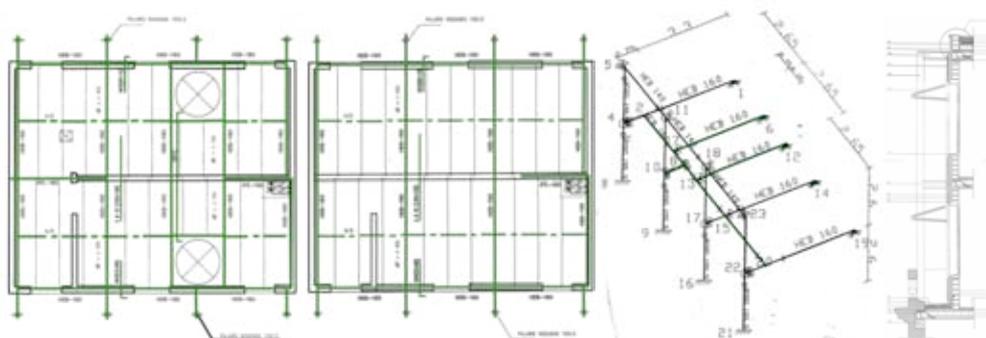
Plantas, isométrica y escantillón de estructura metálica de remonta en San Miquel 47, Barceloneta.
